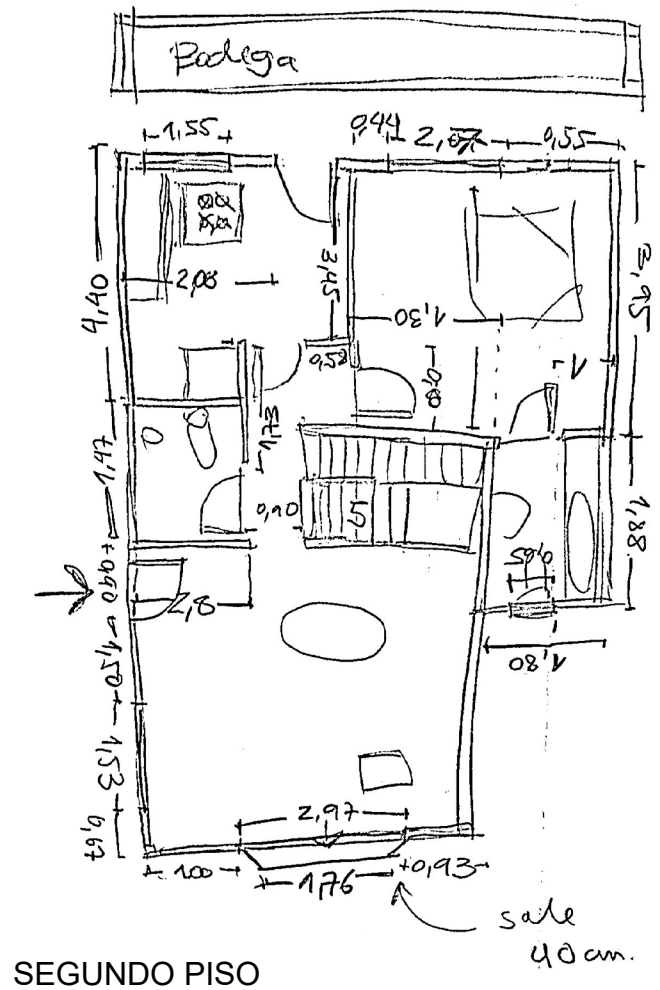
Levantamiento planimétrico hecho en terreno. Vivienda de Mireya. Fuente: Elaboración propia, 2019.
